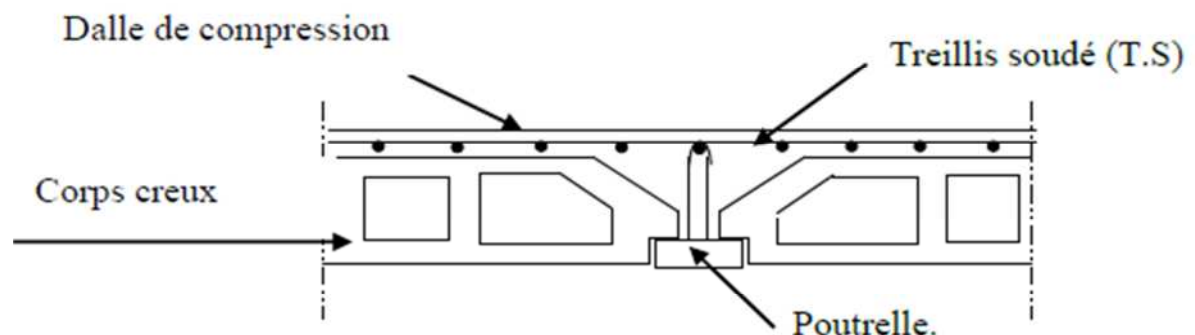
Schéma descriptif d'un plancher courant.
